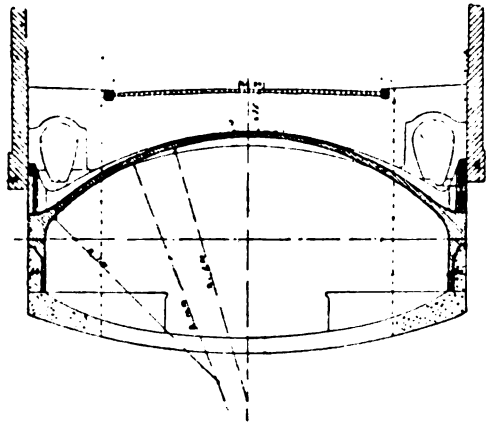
Stazione di Falguière - Sezione trasversale.
